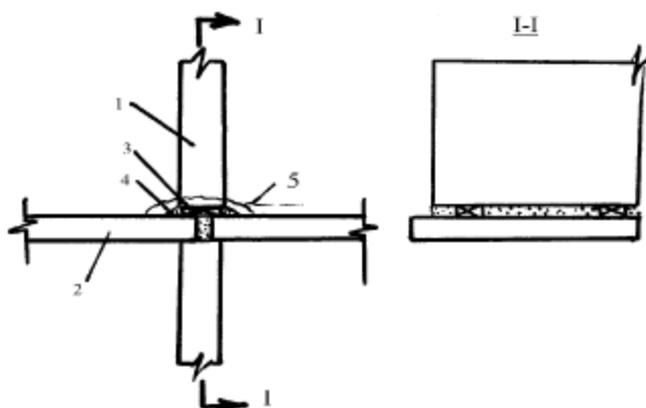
Монтаж элементов надземной части бескаркасного здания:
